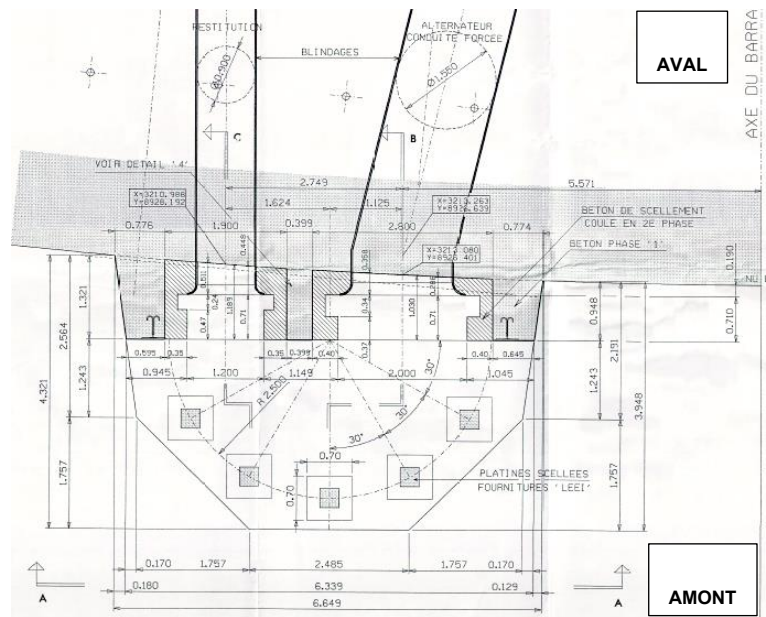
Vue en plan de la tour de prise d'eau usinière et de l'entonnement des conduites
